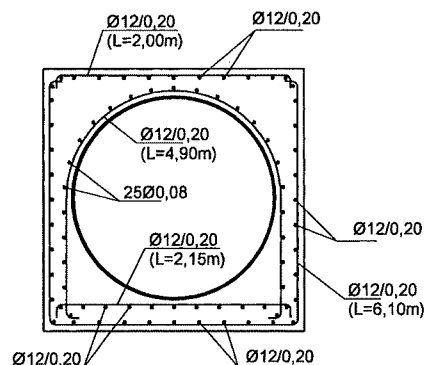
Sección tipo del dado de hormigón con su armadura (RB.4)
